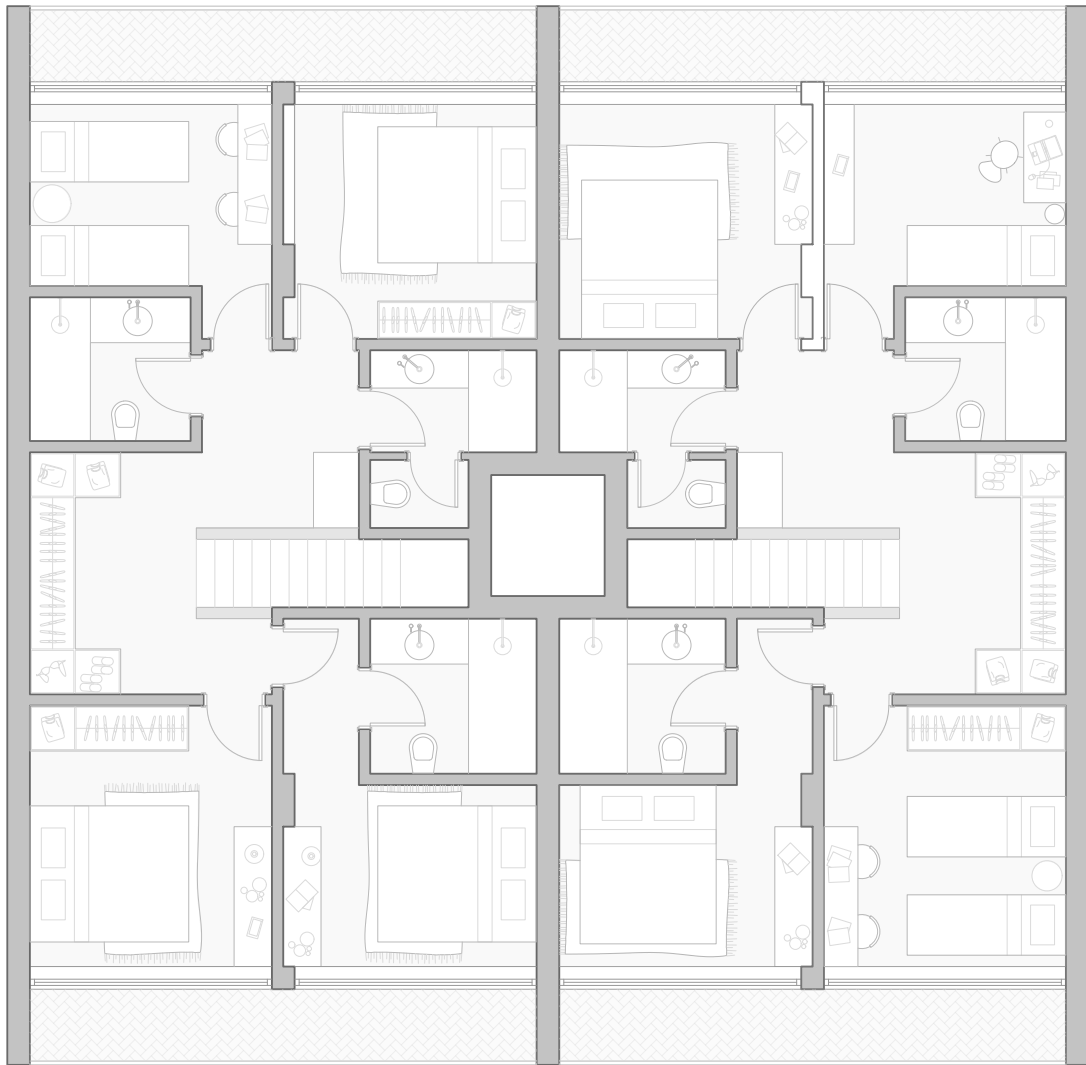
Planta T4 2x2 Piso Superior 1:100
